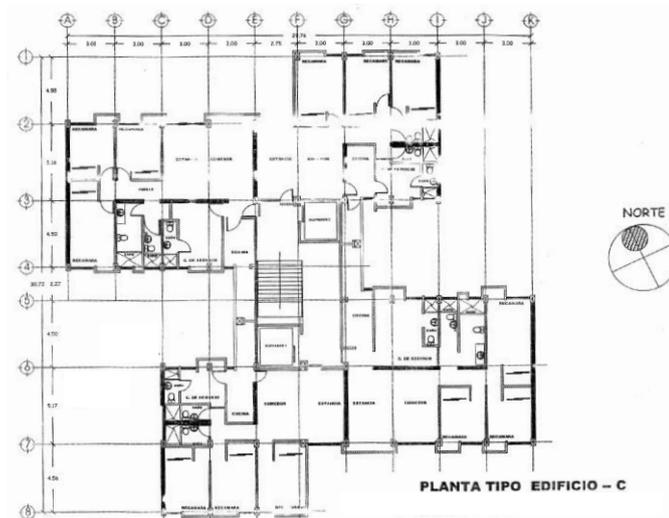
Planta arquitectónica de uno de los edificios tipo. Villa Olímpica. Fuente: Una de las familias entrevistadas
